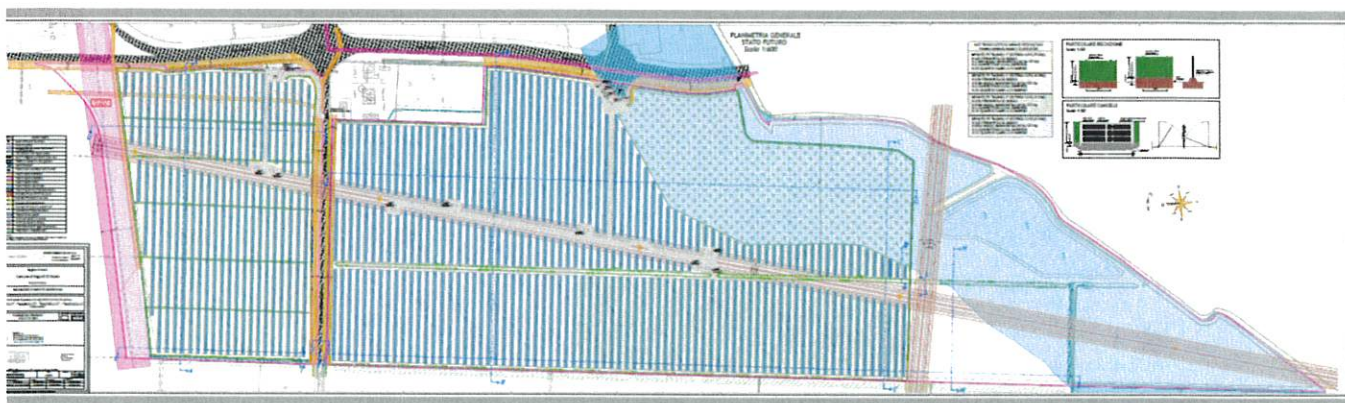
Planimetria generale – stato futuro, dopo della revisione del progetto [Cfr. Elaborato 54_TAVA03_PLAN_FUT_REV01]
